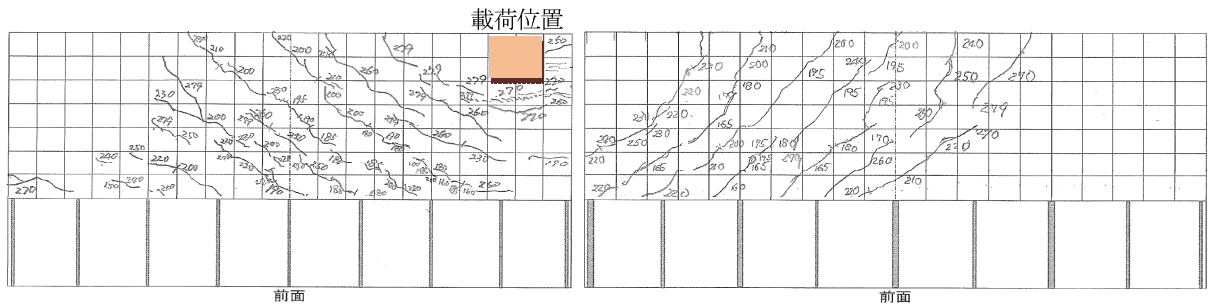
ひび割れ状況 (載荷試験終了時)
